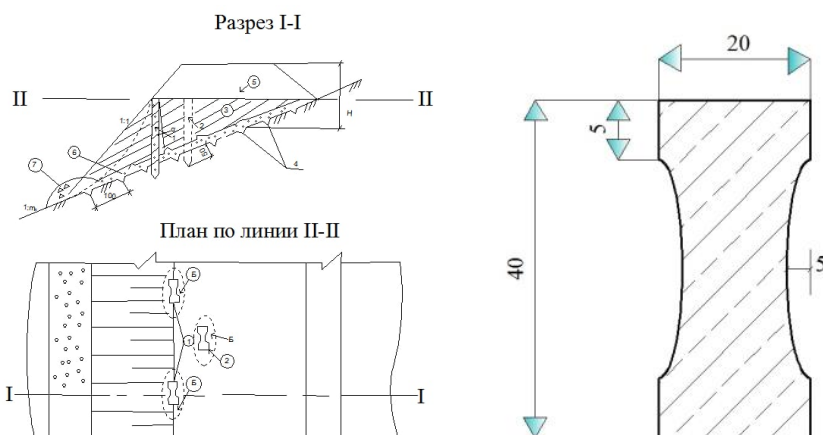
Схема свайного укрепления насыпи земляного полотна.
